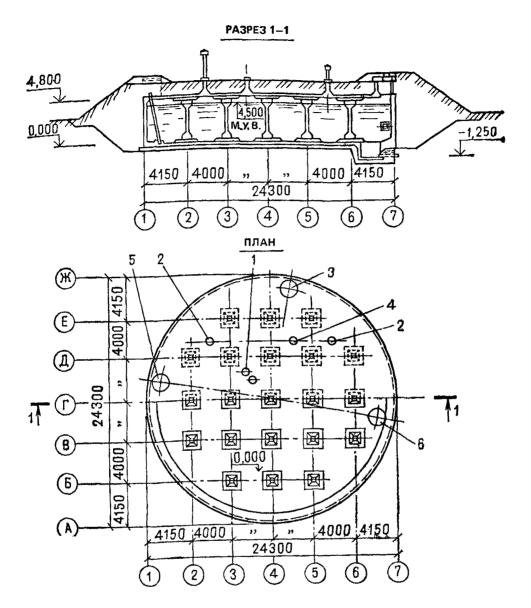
Резервуар для воды вместимостью 2000 м<sup>8</sup> цилиндрический из монолитного железобетона для строительства в районах сейсмичностью 8 и 9 баллов. Тиновой проект 901-4-53с (к ценам № 364, 365)
